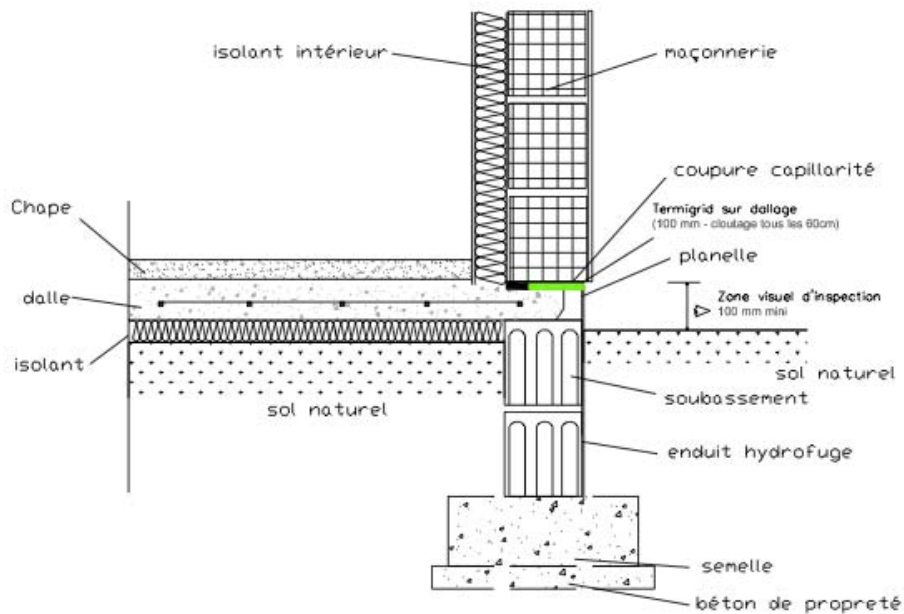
Coupe sur plancher bas constitué d'un terre plein
